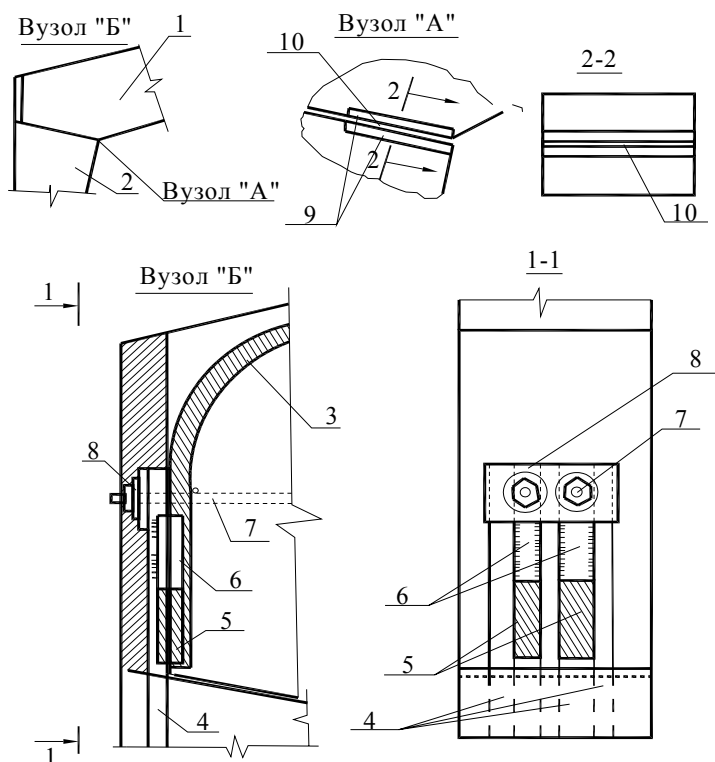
Безварний вузол з'єднання ригеля зі стійкою:
